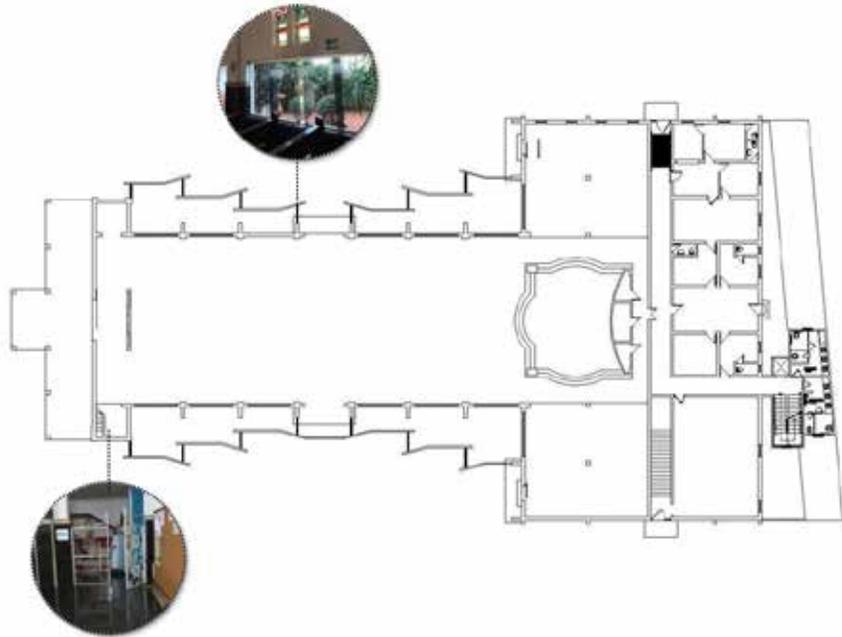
Planta da Igreja Santa Rita de Cássia - Atualmente.
